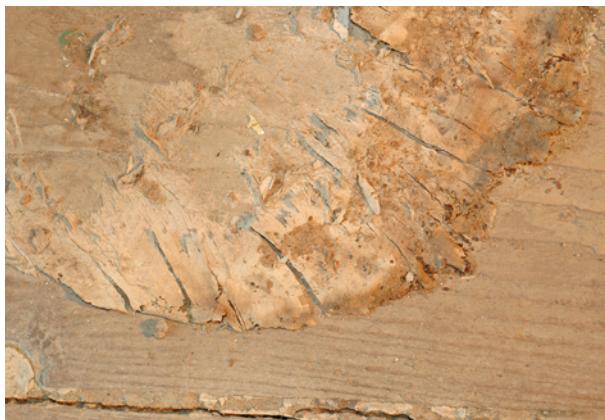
▪ Lappiges Oberflächenmyzel des Echten Hausschwamms. Es lässt sich leicht vom Untergrund abziehen.
